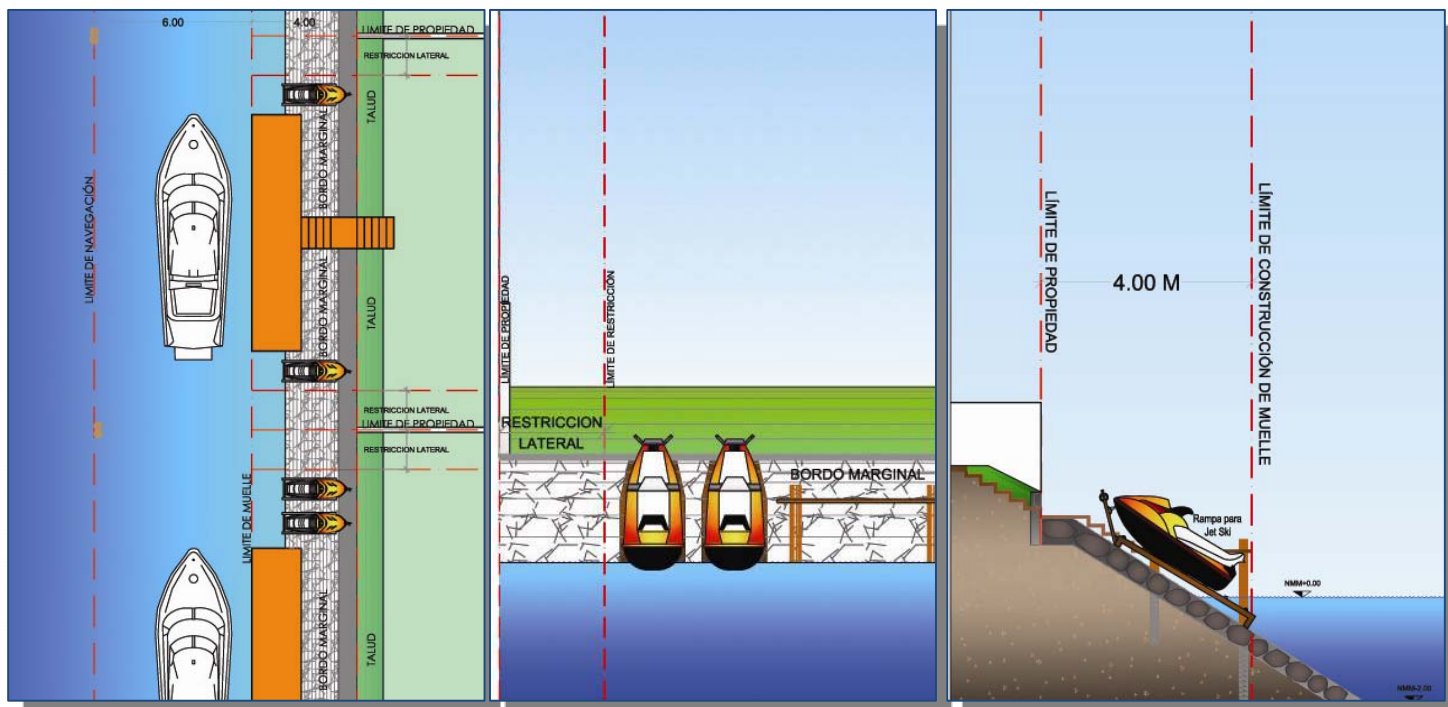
DETALLE DE CONSTRUCCIÓN DE MUELLE Y ESCALERA EN CORTE
